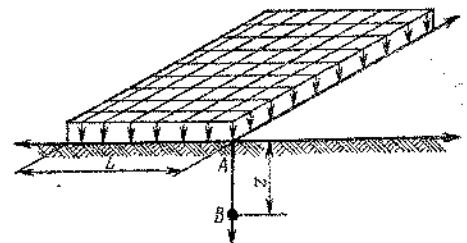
Схема к определению напряжений от нагрузки, распределенной по прямоугольной площадке
